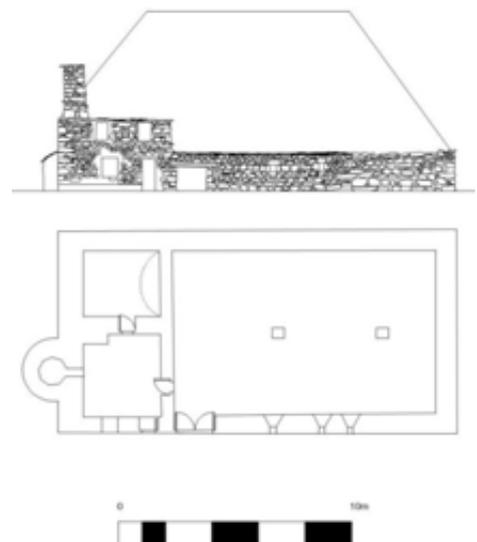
Plan et façade de la ferme-bloc à toiture décalée, d'après les relevés de la ferme Philip, Sainte-Eulalie (07)
